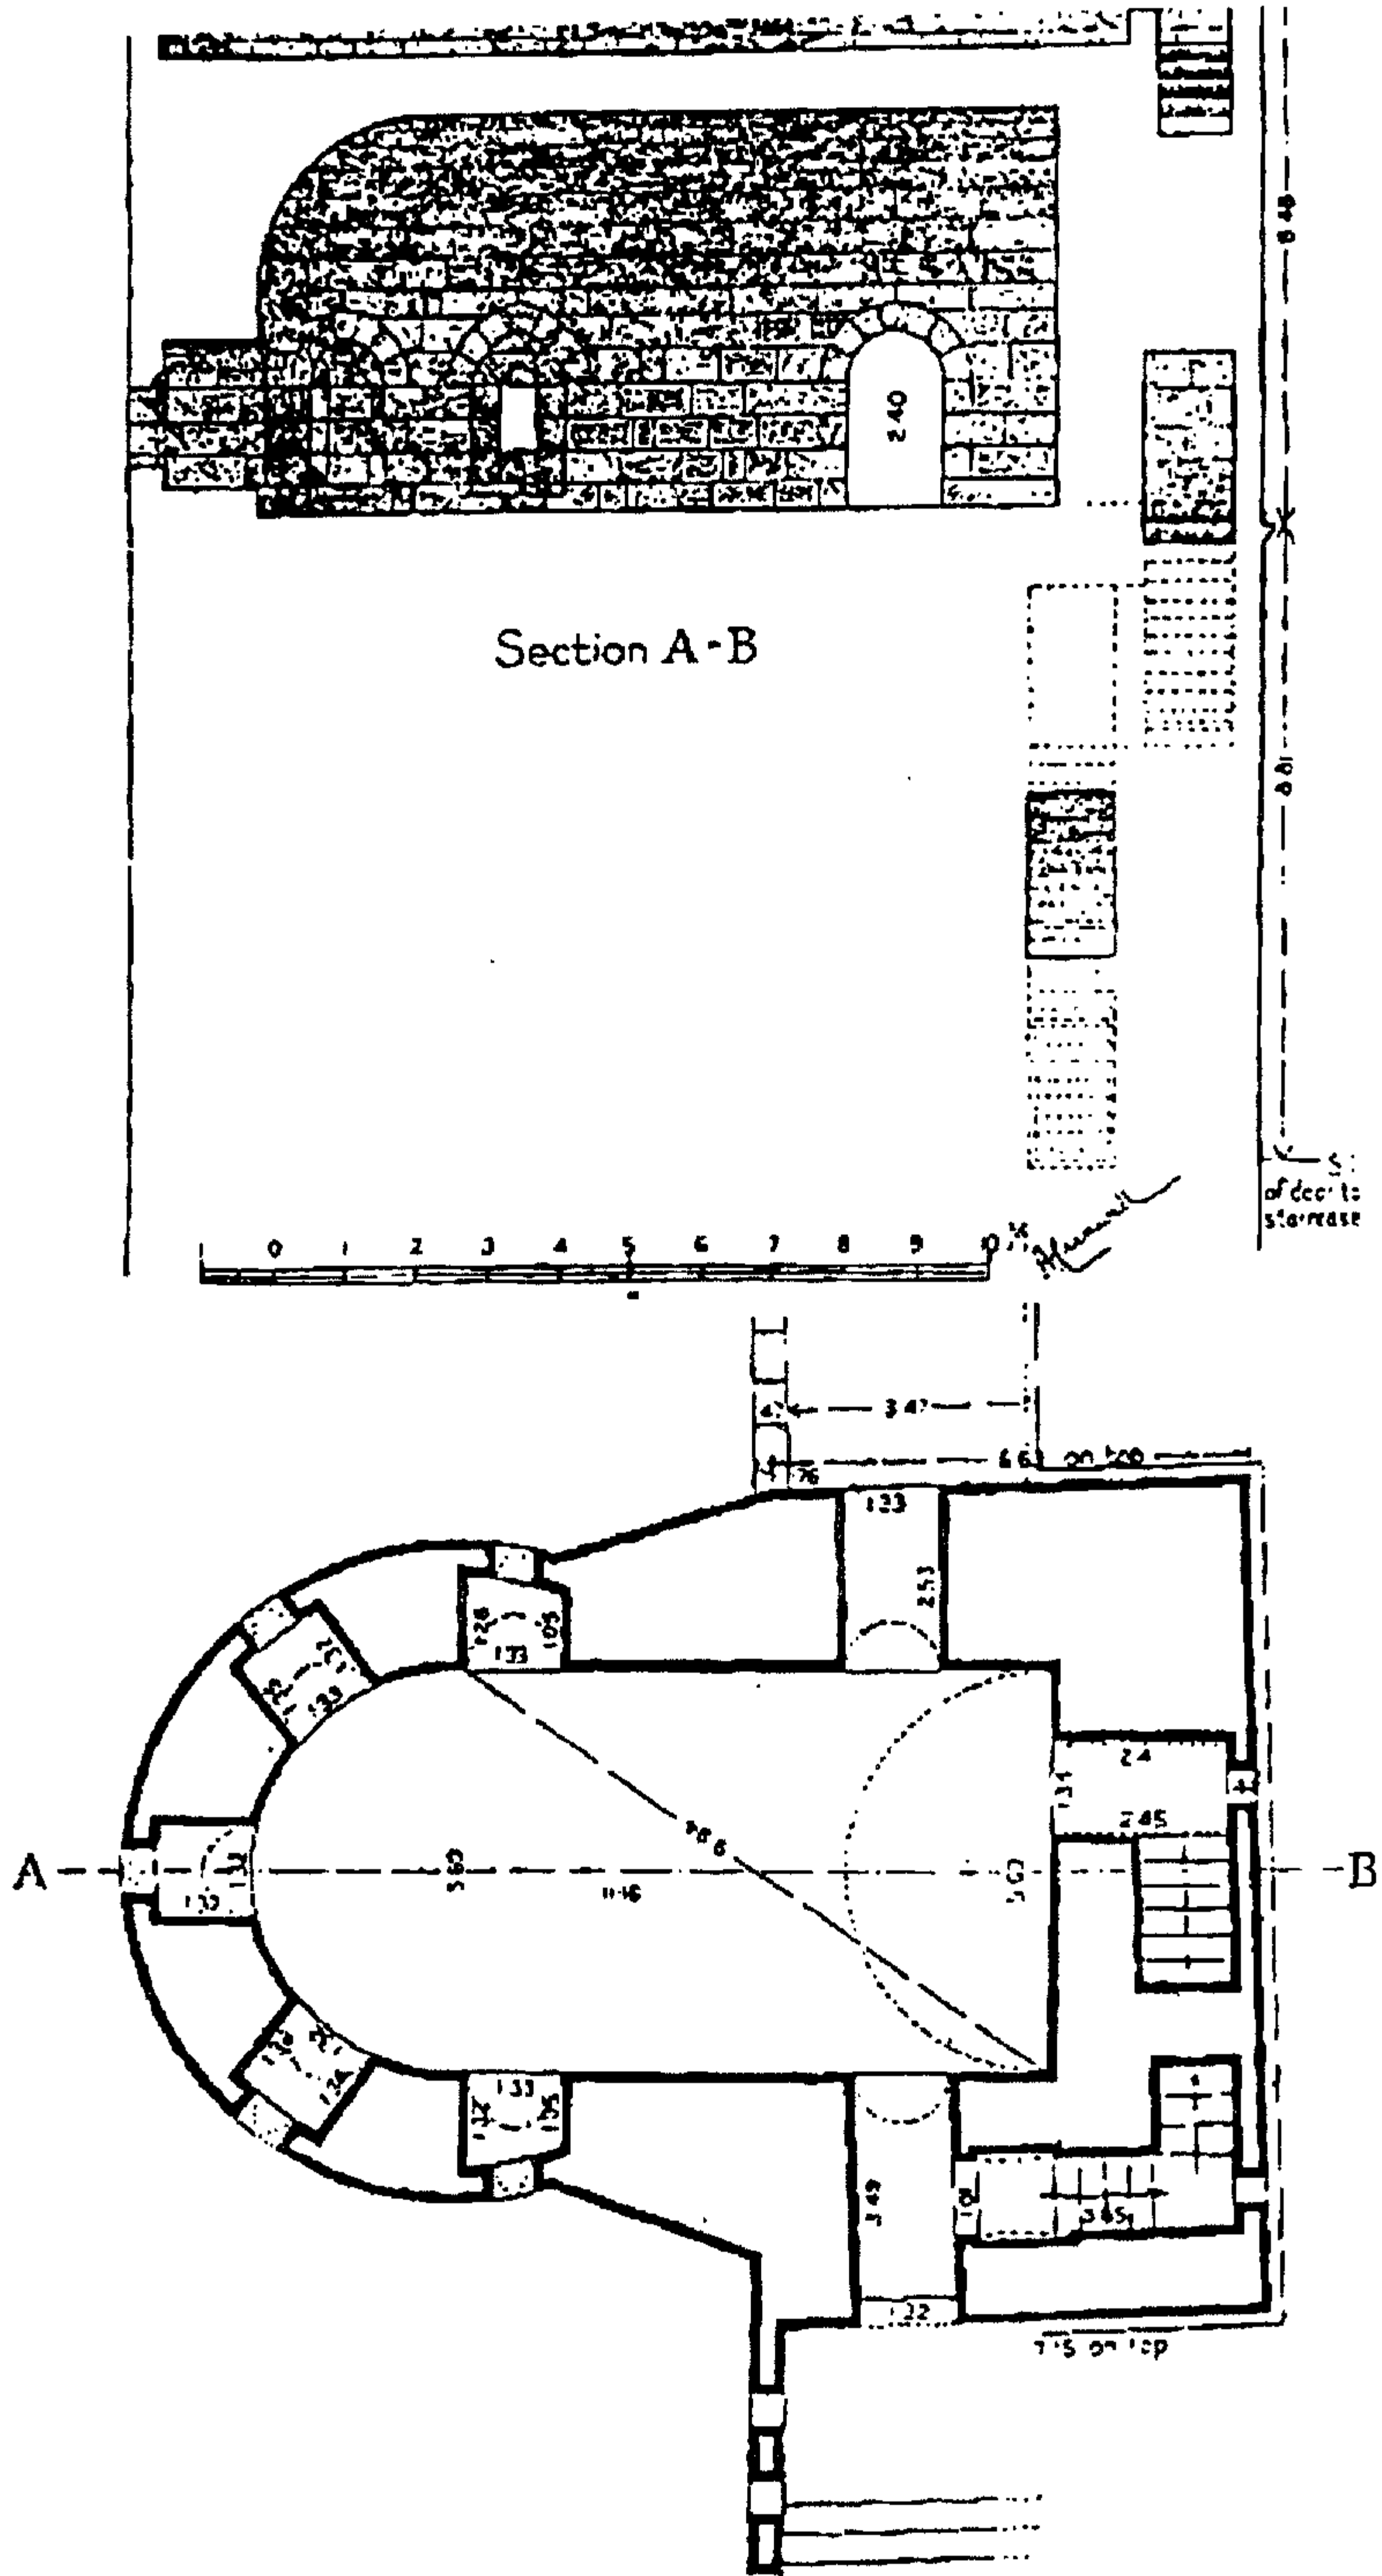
مسقط أفقى لباب زويله (المستوى الثانى) .
